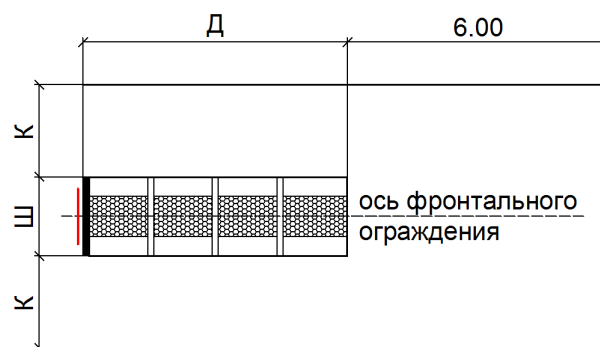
Схема натуральных испытаний фронтального ограждения
